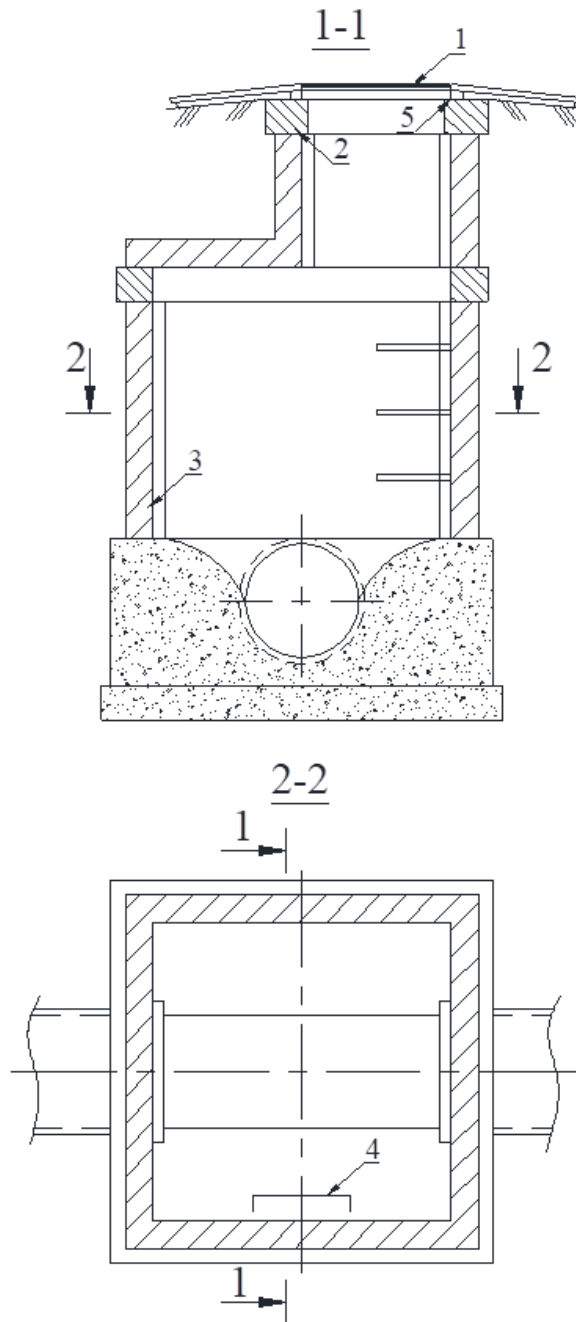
Прямокутна збірна залізобетонна оглядова шахта:
